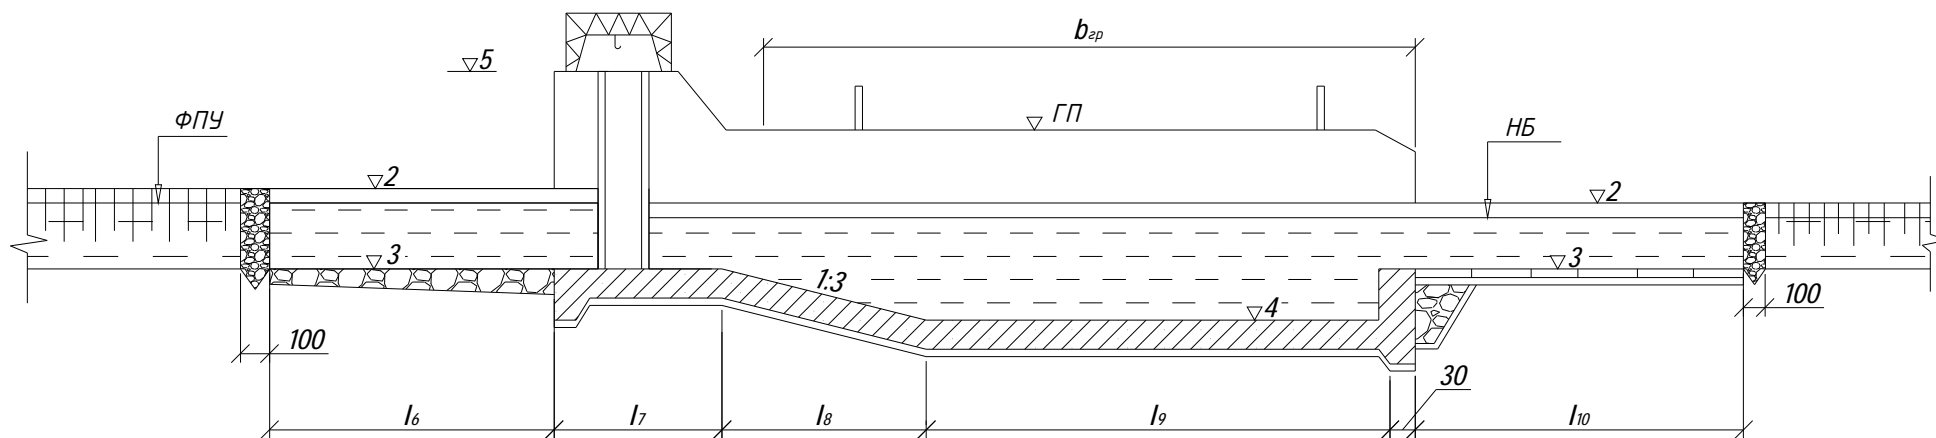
Расчетная схема водосбросного шлюза и виды сопряжения его с подводящим каналом:
